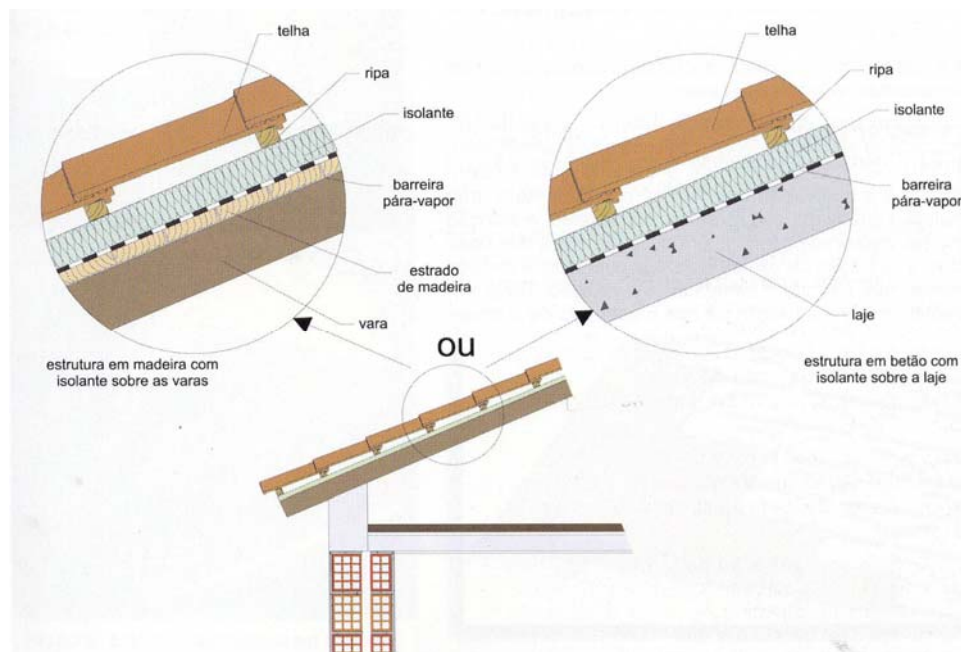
Desvão útil com laje inclinada ou tecto estanque ao ar
